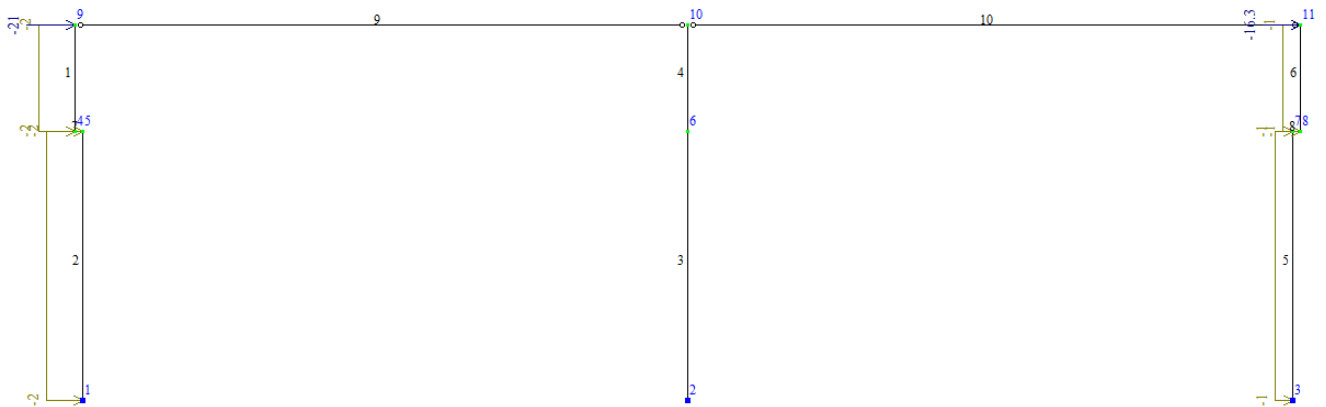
Розрахункова схема від вітрового навантаження Л-П.
